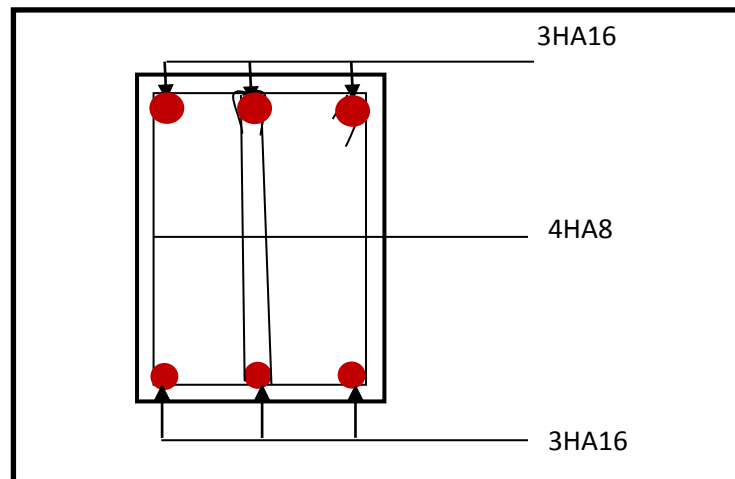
Ferraillage en travée d'une poutre principale.
